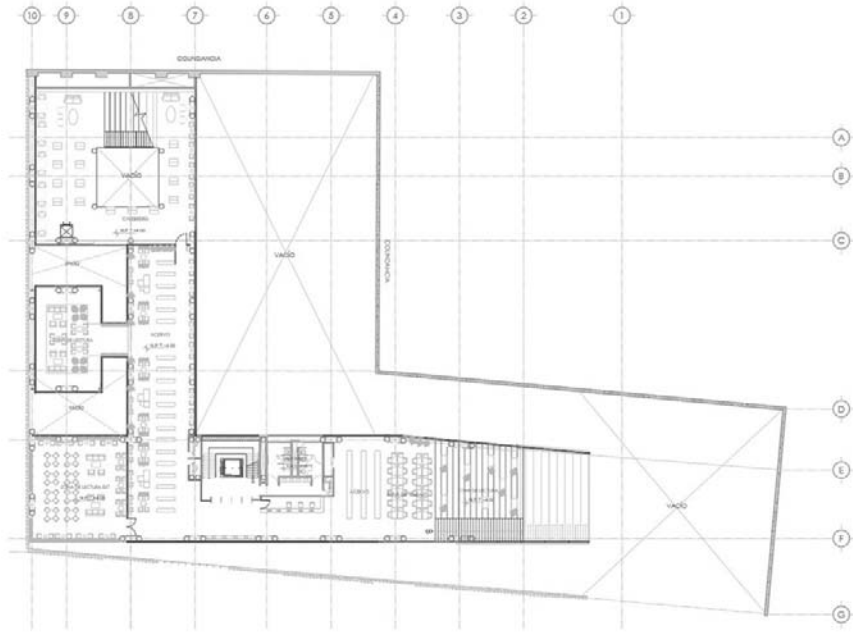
Plano de planta primer nivel, [elaboración propia].
